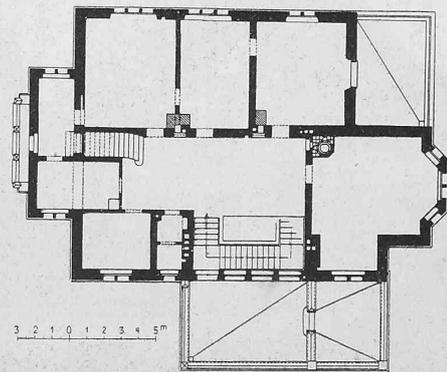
Grundriss vom ersten Obergeschoss.
